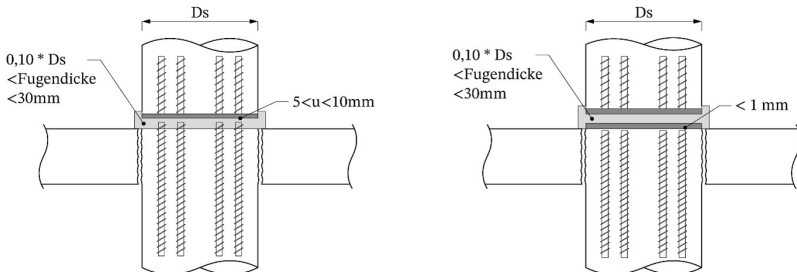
Kraftdurchleitung im Deckenbereich bei Stützen mit hochfestem Bewehrungsstahl
